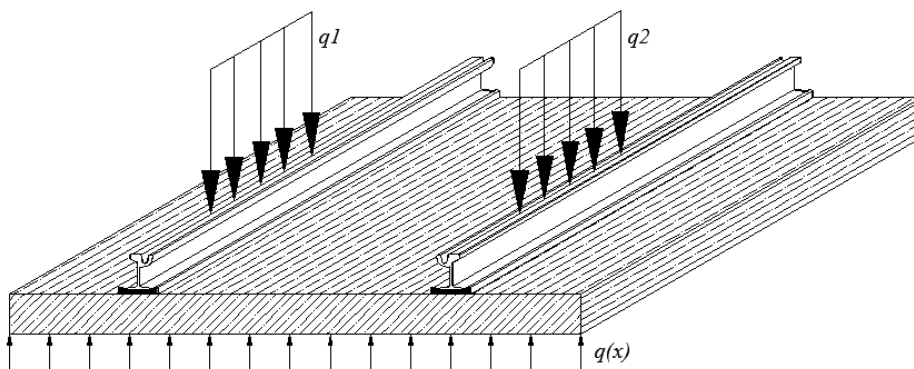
Схема передачи нагрузки на несущее бетонное основание при коэффициенте постели подошвенного вкладыша 130 МПа
